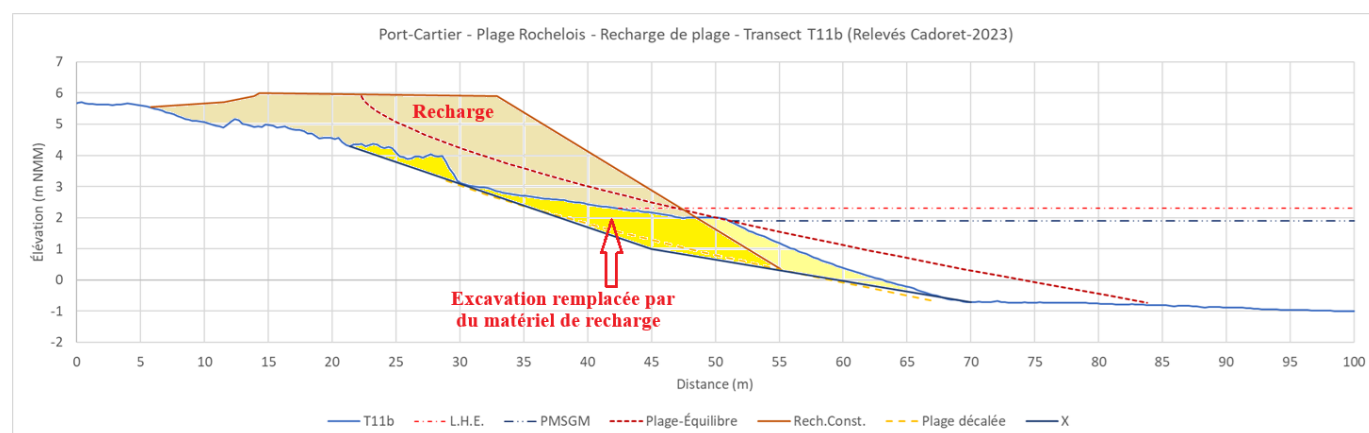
Coupe-type de la recharge de plage option V3 avec excavation préalable de la plage actuelle
